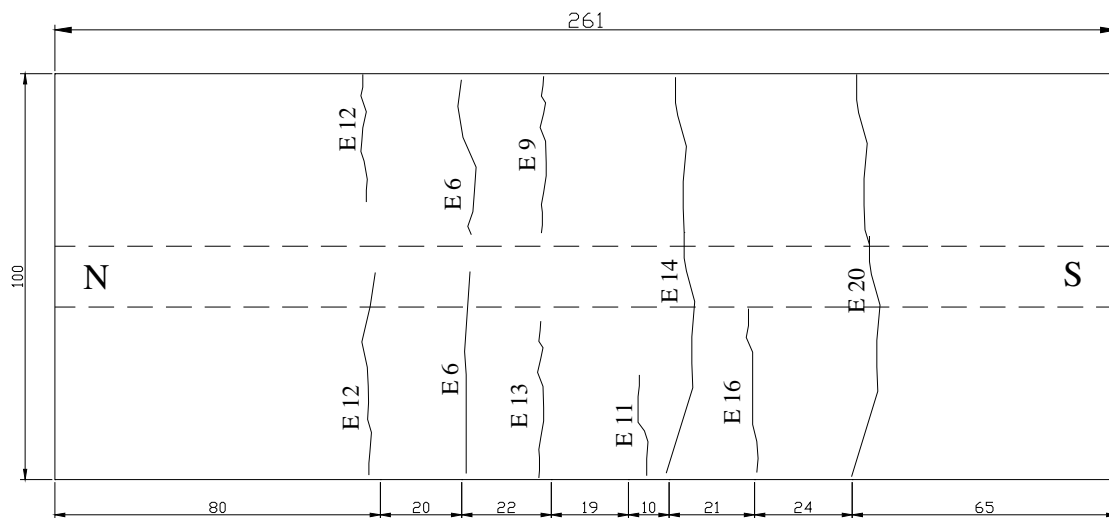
Fissuras do modelo 2A (face superior da laje) – medidas em cm.
